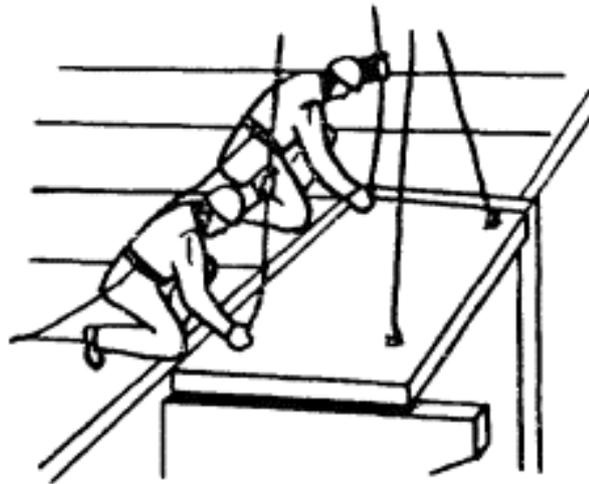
Расстроповка плиты перекрытия
